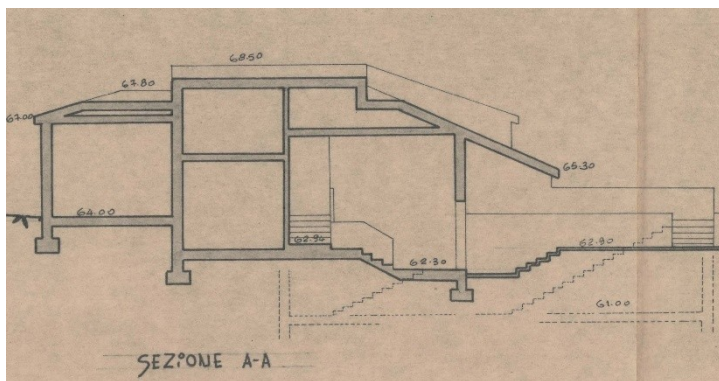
Stralcio C.E. 1147/89 – Sezione
